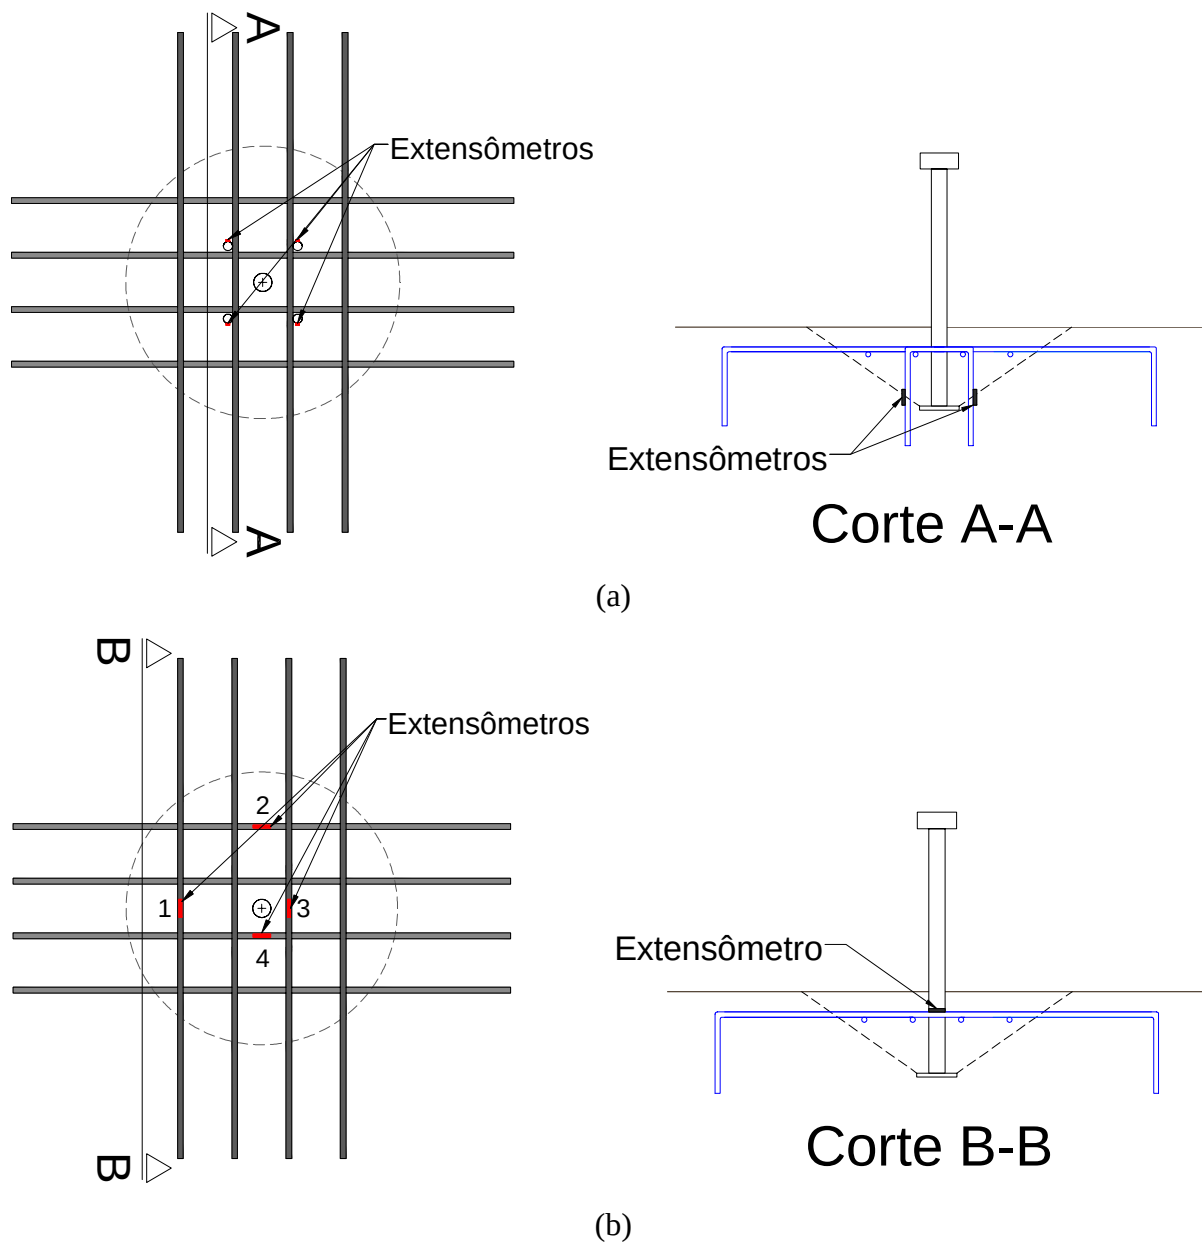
Detalhe genérico do posicionamento dos extensômetros: (a) na armadura de cisalhamento, (b) na armadura de flexão.
